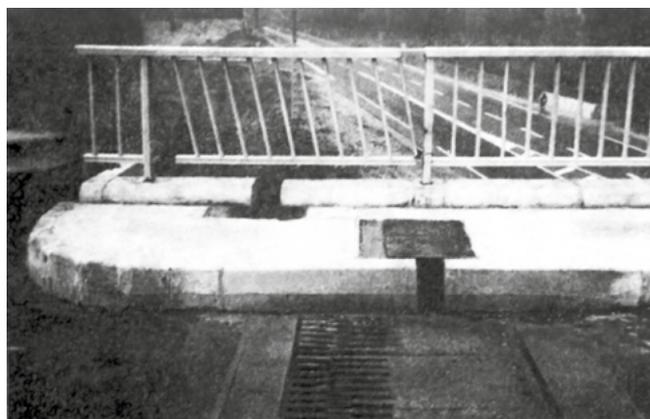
Exemple d'une disposition à éviter : le vide du joint de trottoir sert d'avaloir
